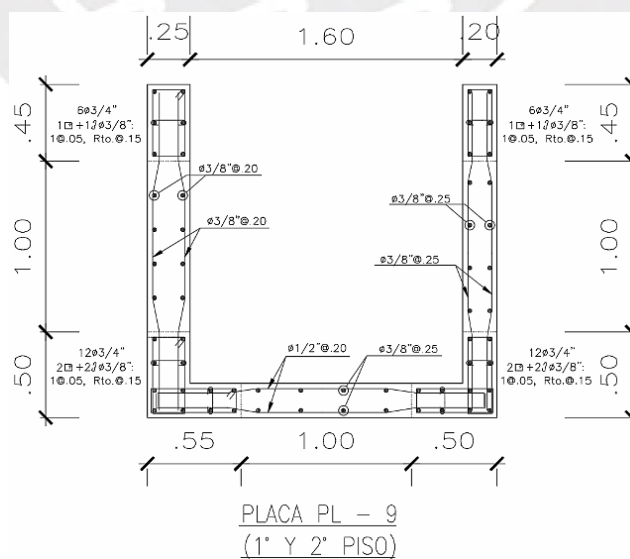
Detalle de armado de la placa PL-9 de sistema de muros
